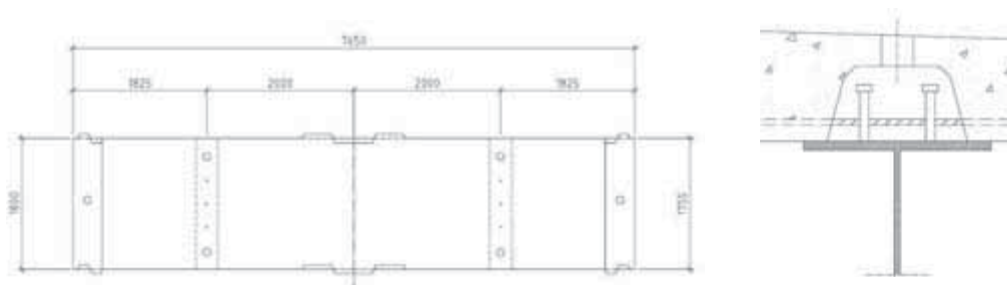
Plan d'un élément de tablier de pont et section transversale au-dessus d'une poutre.
